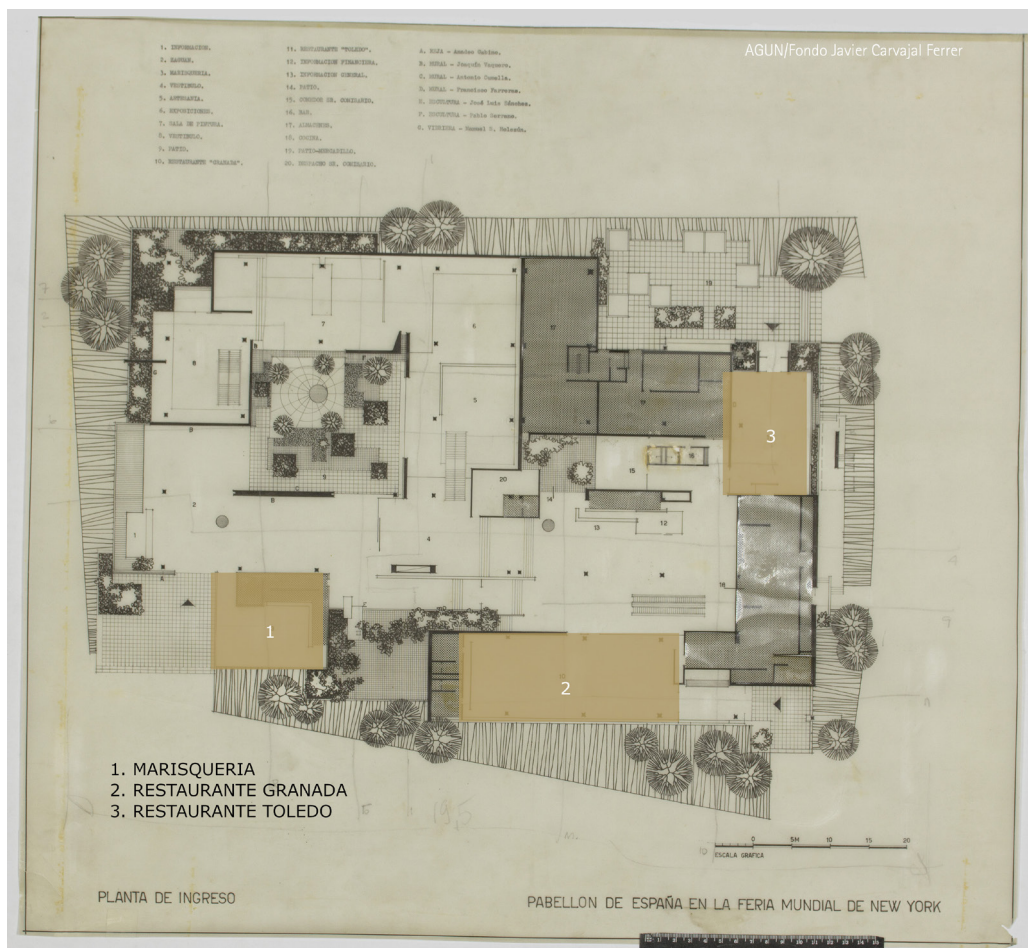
Planta del Pabellón español en la Exposición de Nueva York, 1964. Fuente: fondo Javier Carvajal, Archivo General UNAV.
